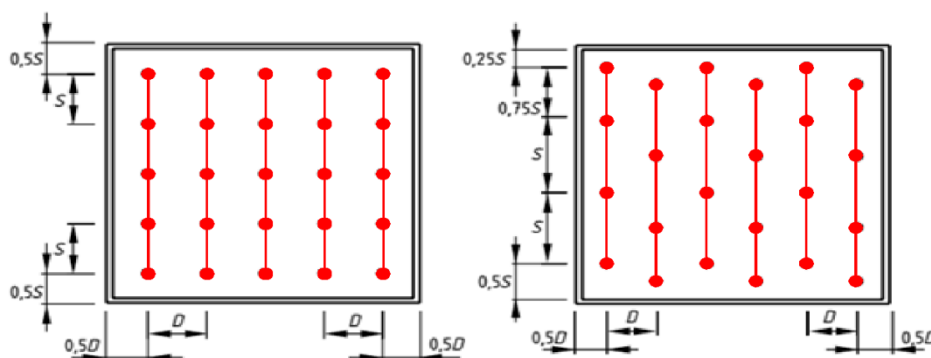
Distâncias máximas em instalações de sprinklers (adaptado de [14])
